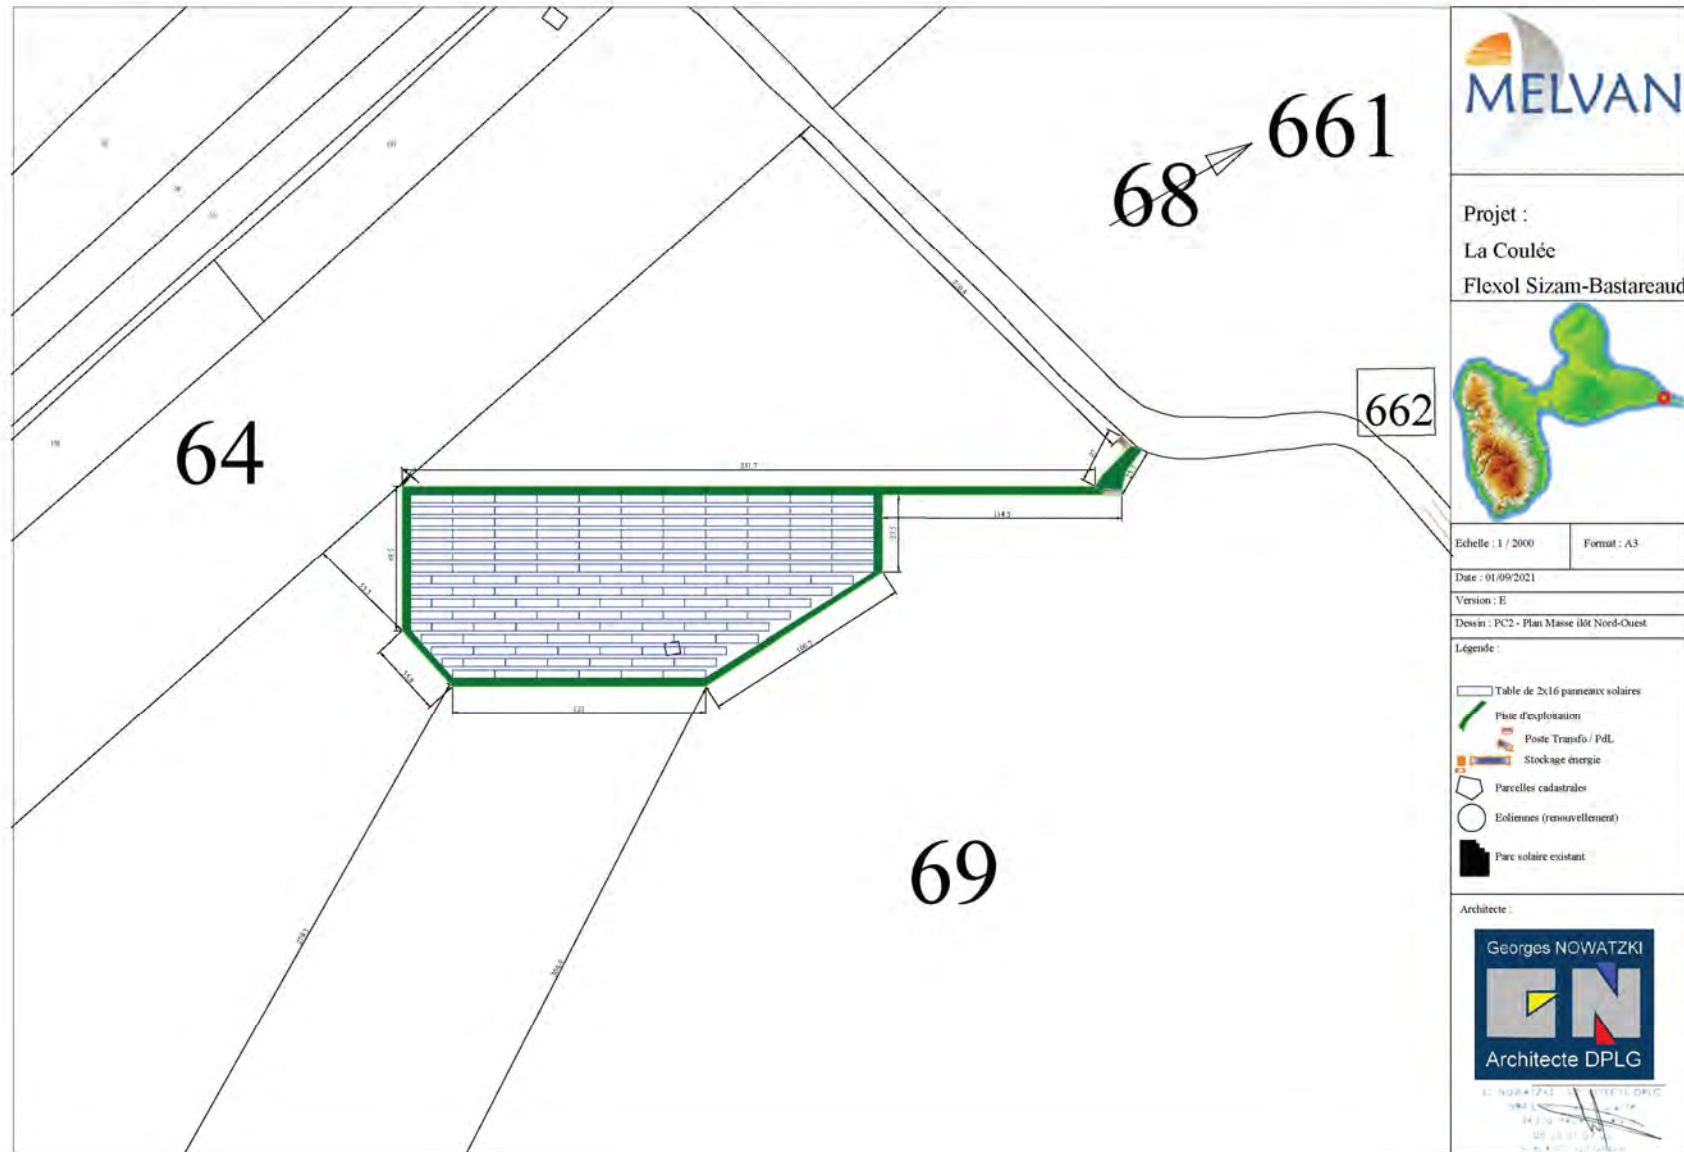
Plan de masse du parc Nord-Ouest (Melvan)
